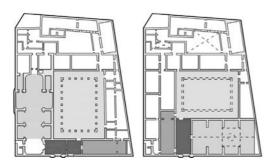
Comparación entre la Planta Actual y la Planta Hipotética de 1589
